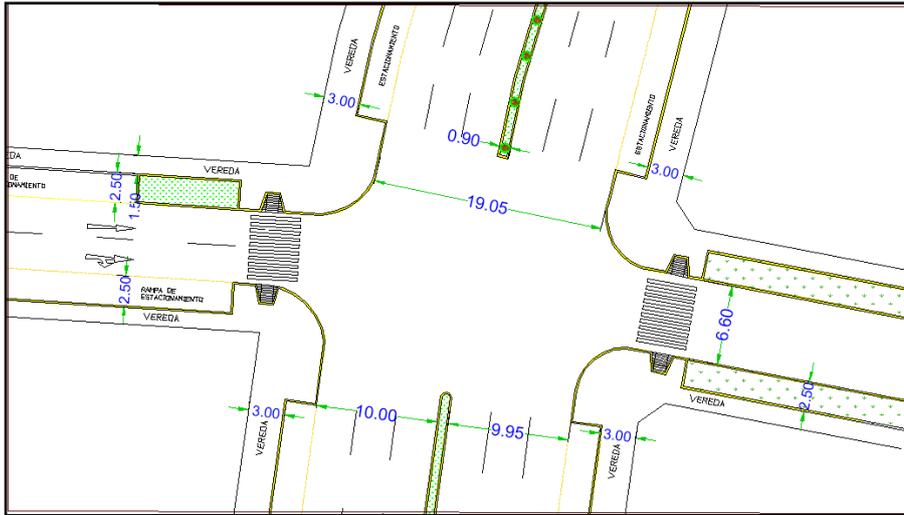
Vista en planta de la situación actual de la Av. Parinacochas con Antonio de la Guerra
